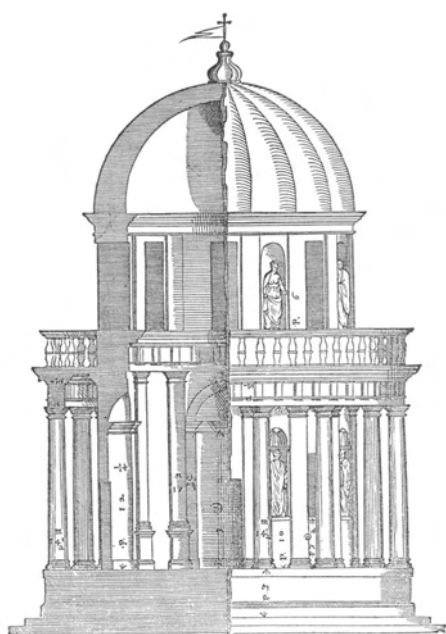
Tempietto de San Pietro in Montorio, Bramante - Fonte: Palladio, 1570.
